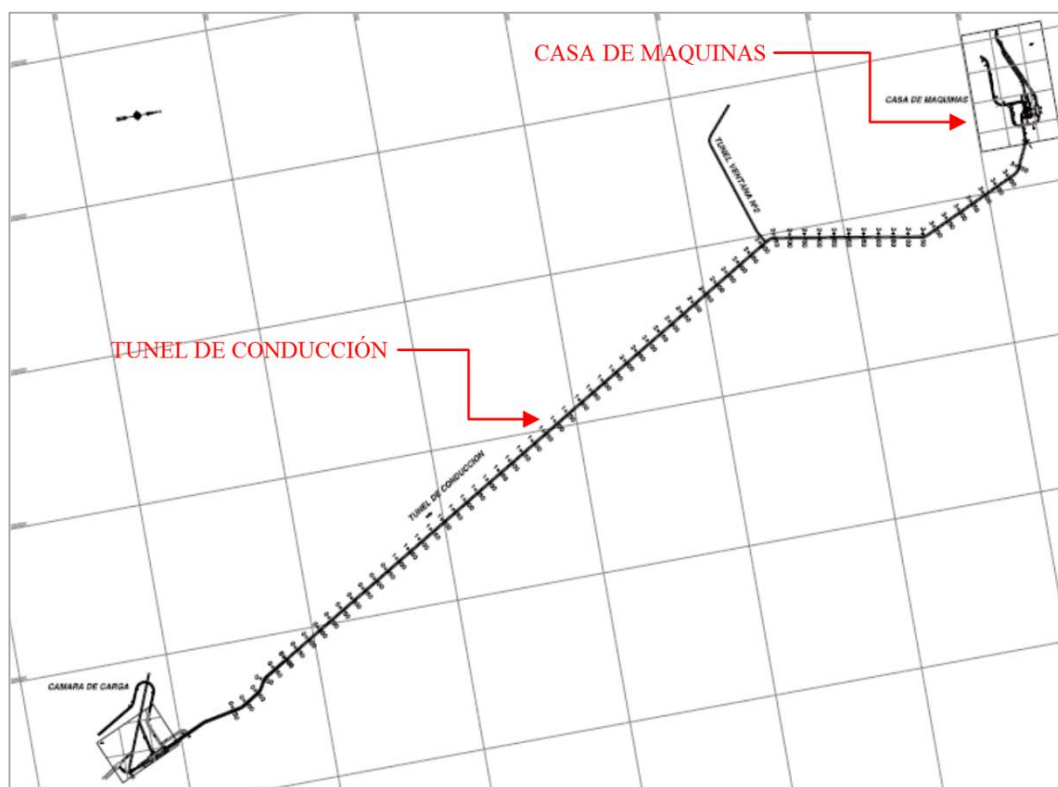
Esquema de planta de la Central Hidroeléctrica de Santa Teresa.
